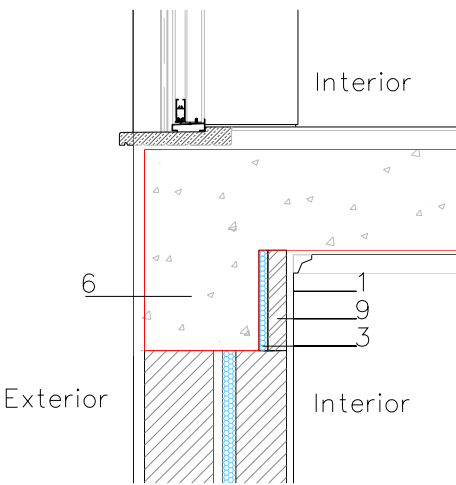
Ligação da fachada com pavimentos intermédios (corte vertical).
